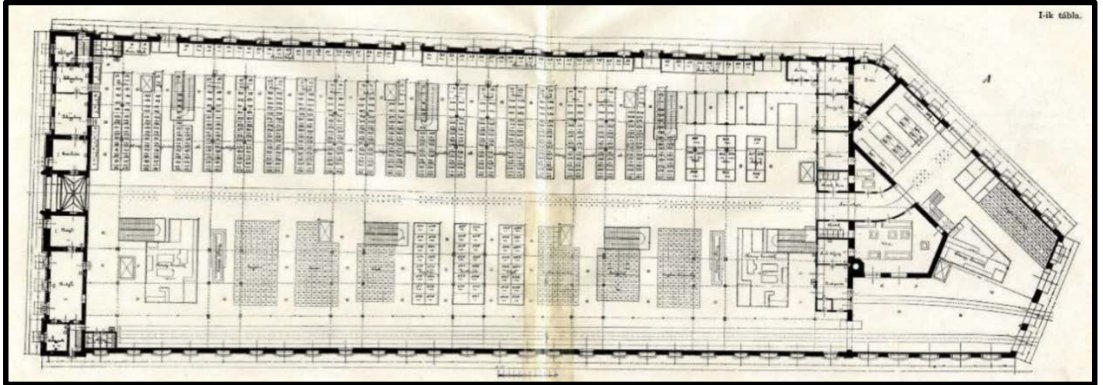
Great Market Hall Budapest, Bodrum Kat Planı (Hungaricana, 2021)
